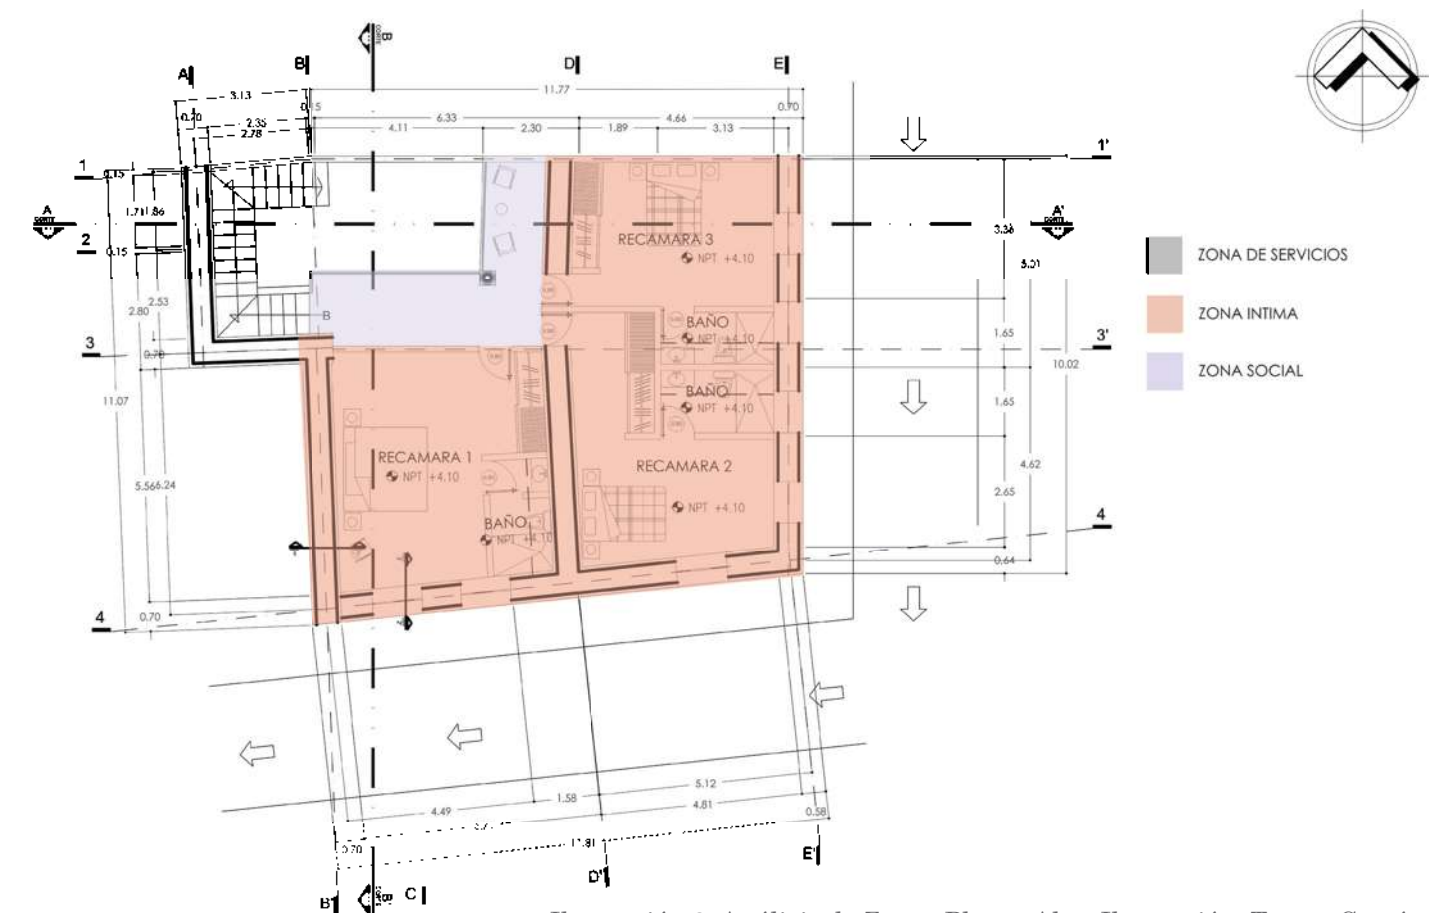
Análisis de Zonas Planta Alta, Ilustración: Teresa García
